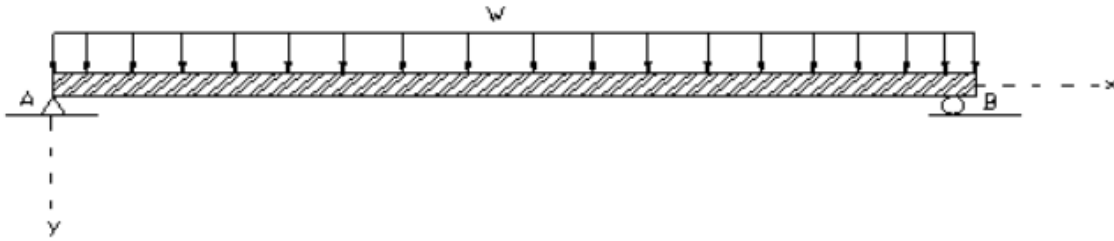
Carga muerta sobre un tramo de 40 metros del puente. Elaboración propia
